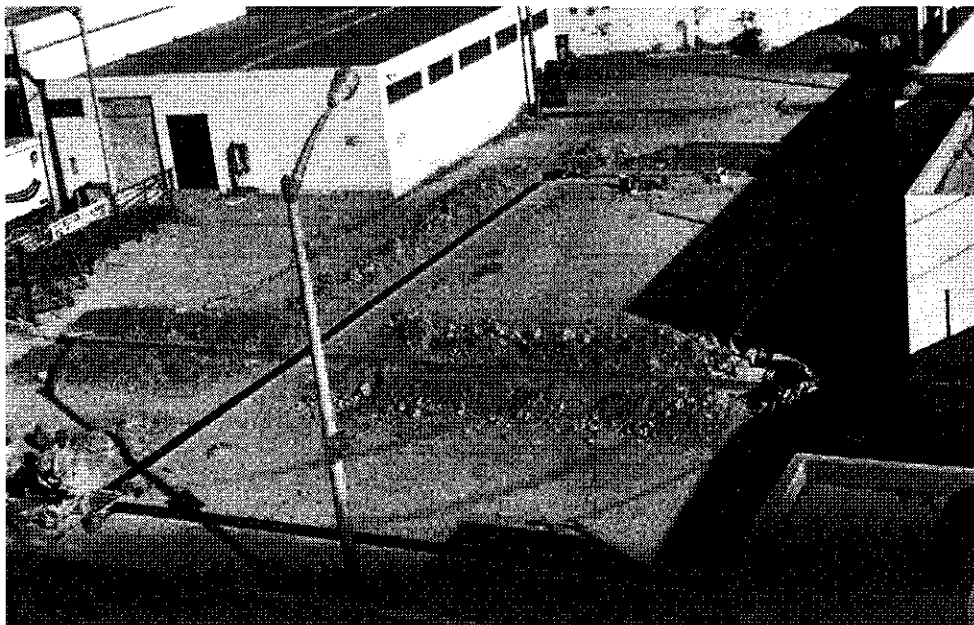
VISTA PANORAMICA CANALETAS DE CONCRETO CON REJILLAS METALICAS.
